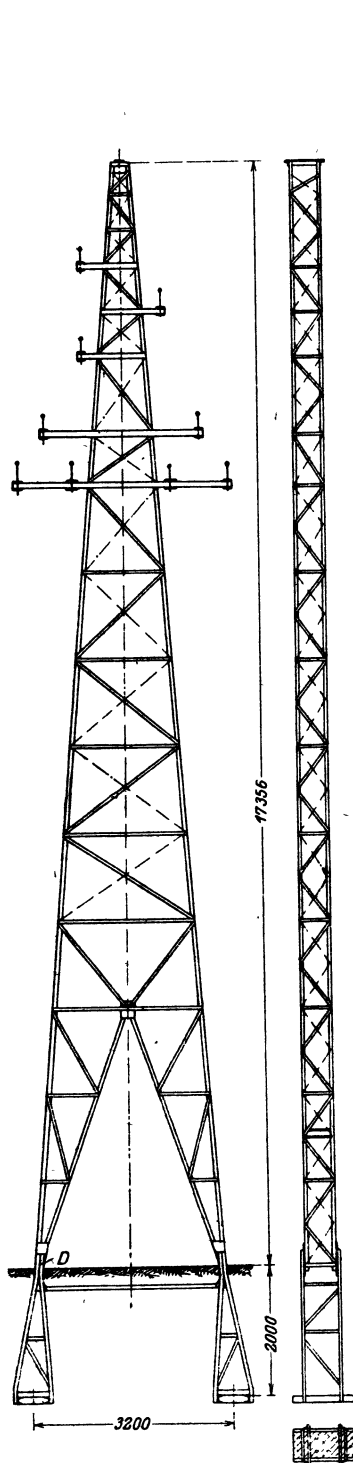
E.W. Saarlouis-Wallerfangen. Tragmast, Höhe 17,3 m, 1250 kg Zug, 9 Leitungen an Stützisolatoren, 1 Erdungsseil. Spreizung senkrecht zu den Leitungen. Fundierung durch Eisenbetonplatten. Aufstellen durch Hochkippen um den Drehpunkt am Fuß. Jucho.
